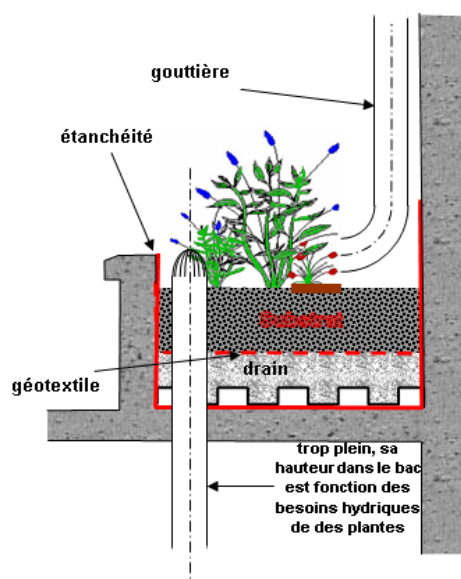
Coupe de principe et illustration montrant une jardinière sur dalle dans lesquelles se jette la gouttière d'un immeuble
